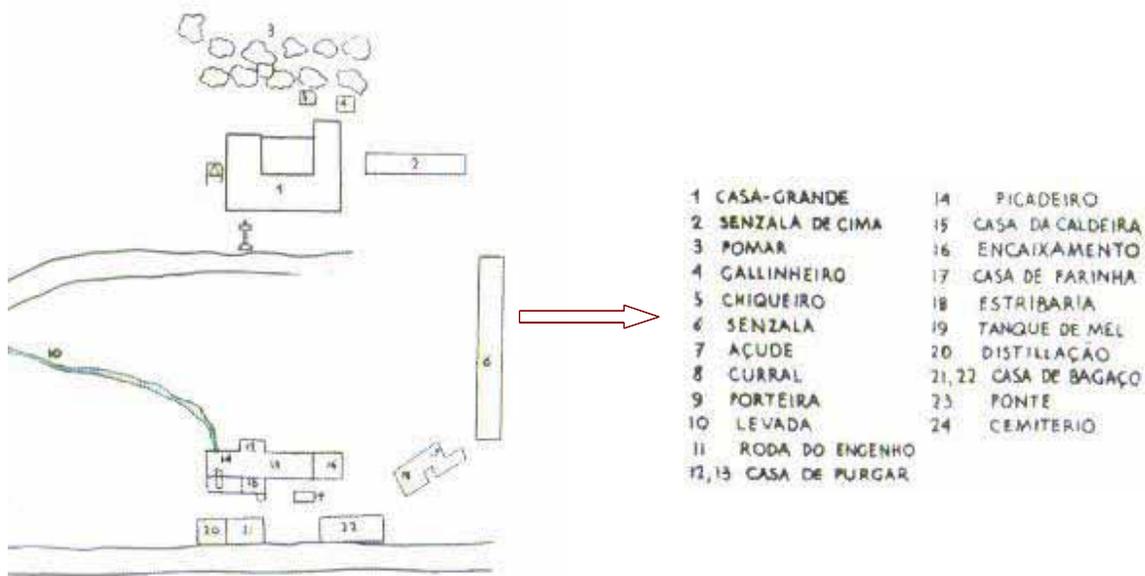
Planta baixa das estruturas do Engenho Noruega e legenda com a descrição das estruturas¹⁷.
